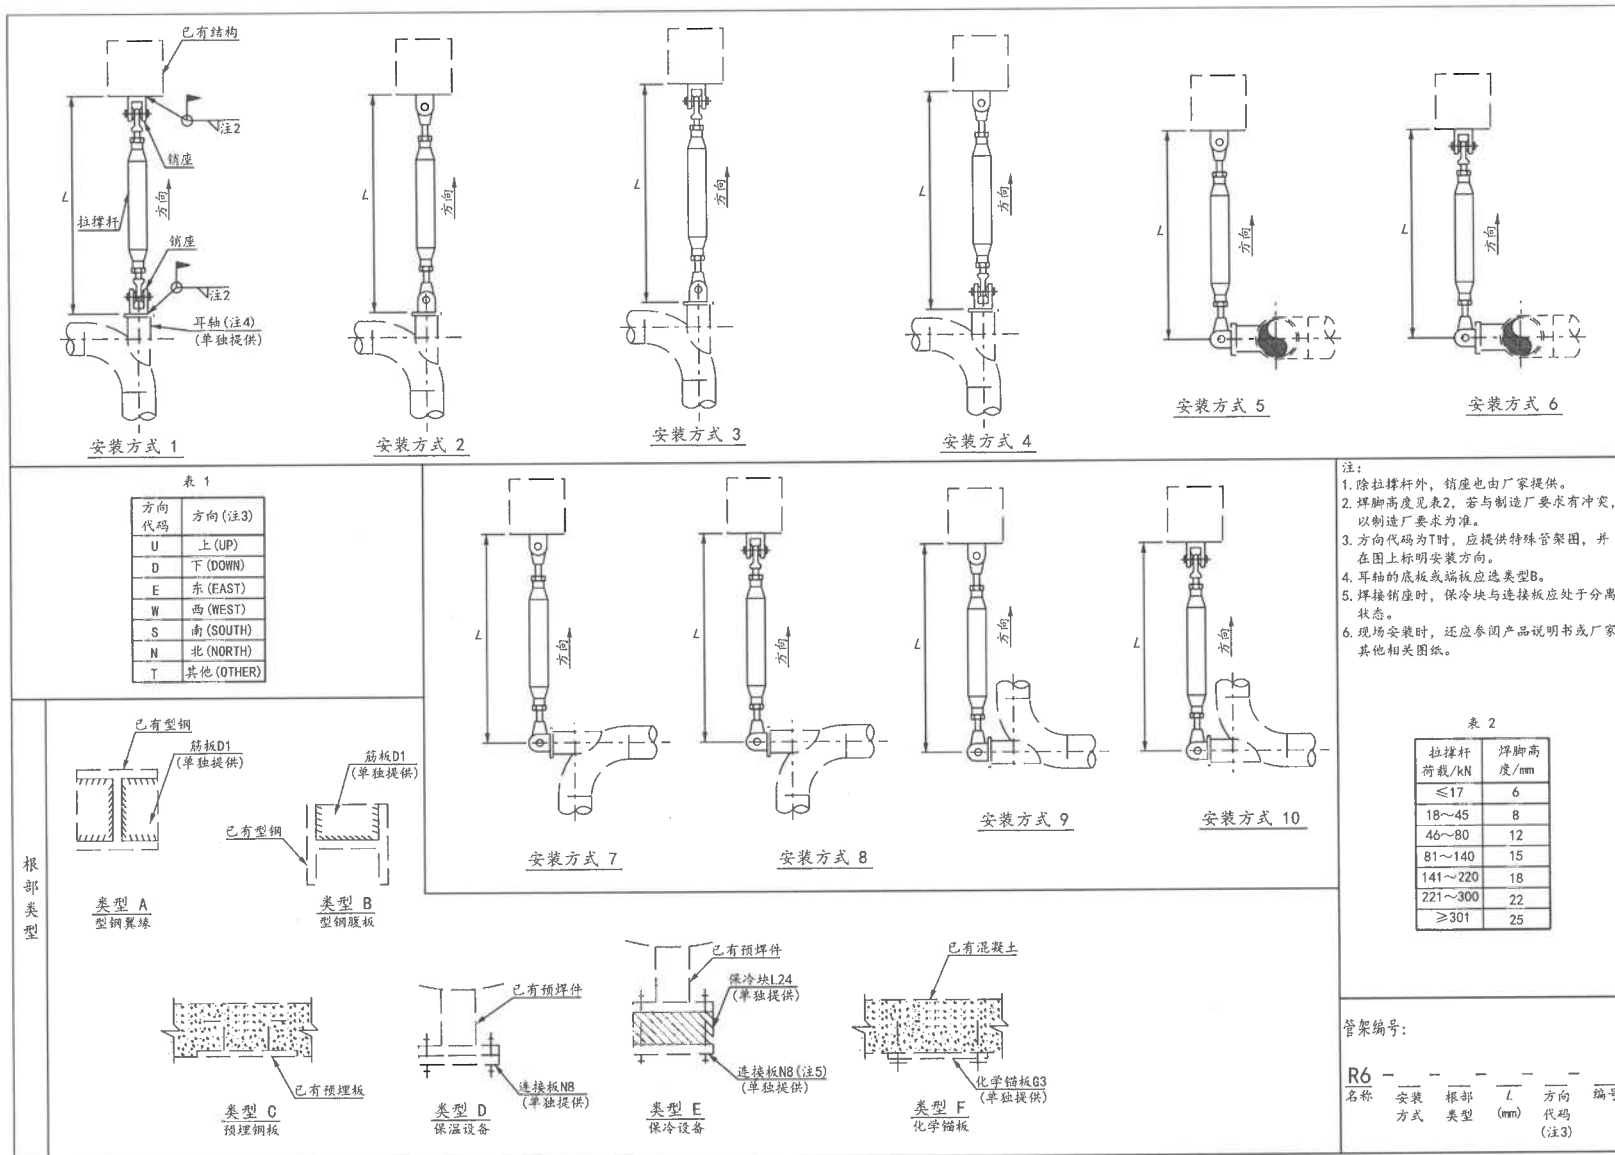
焊接型刚性拉撑杆(弯头耳轴)
